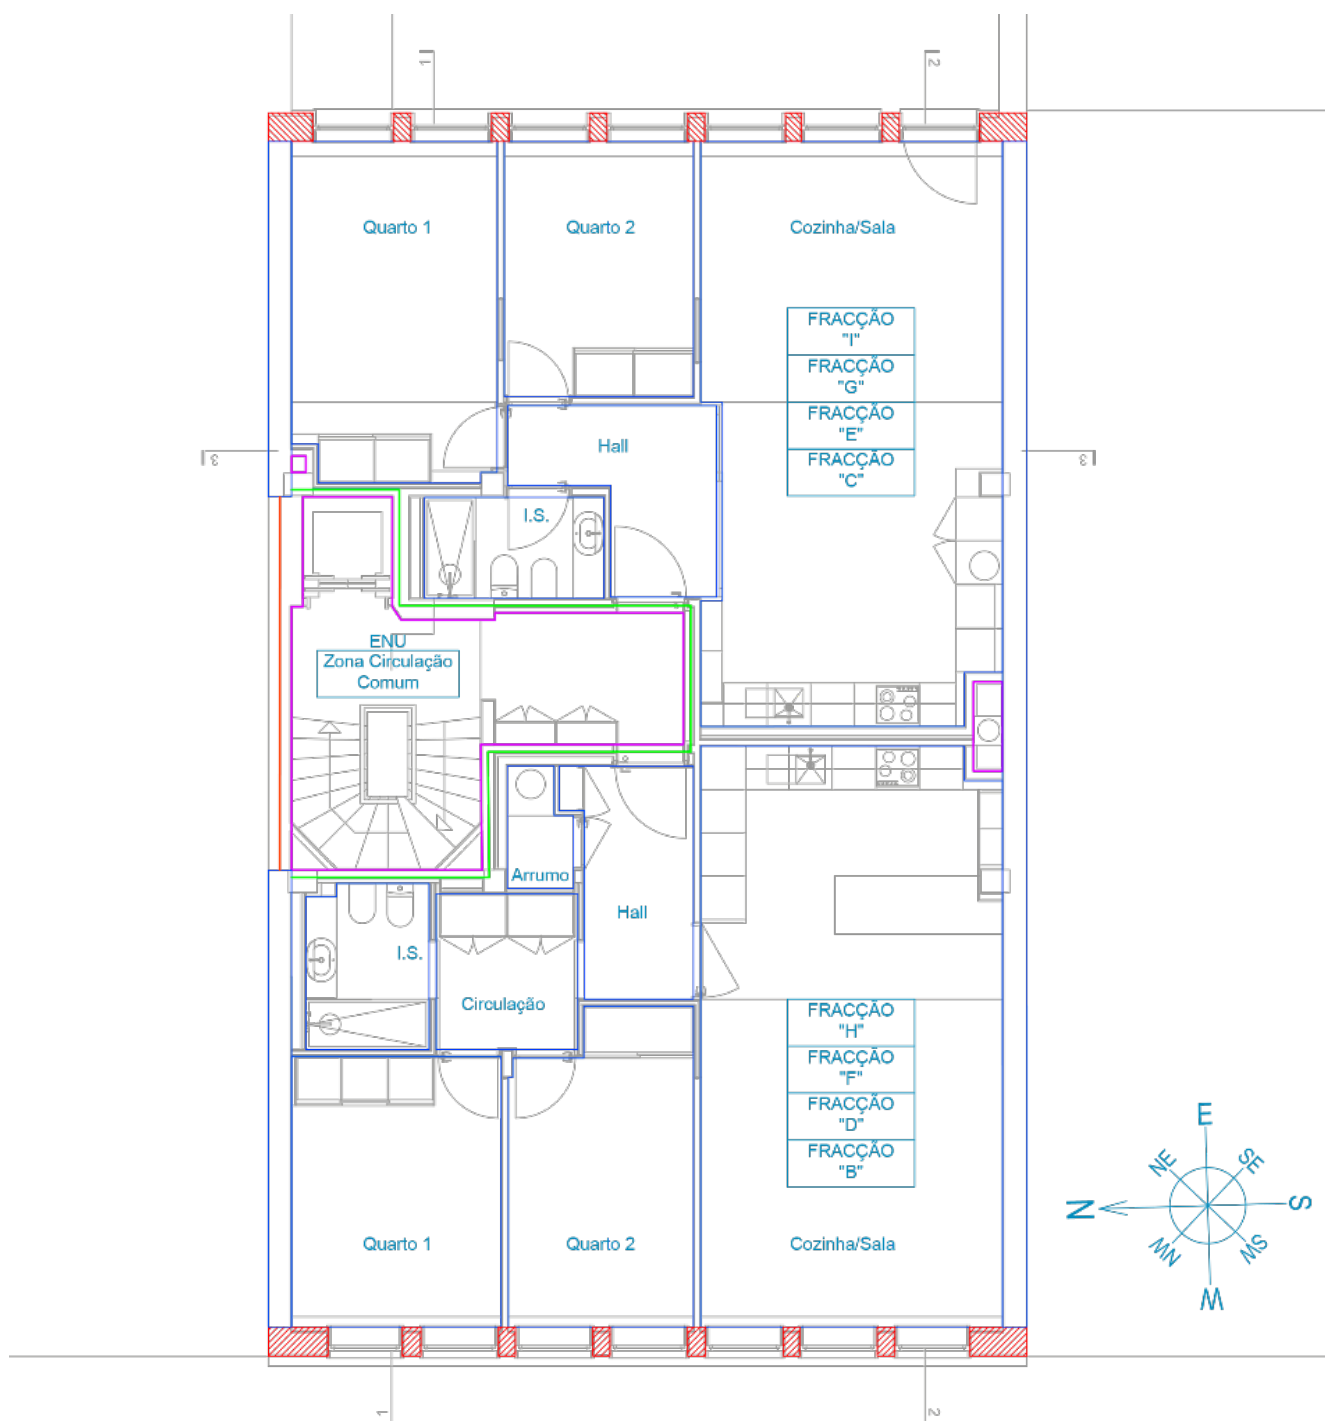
Planta do piso tipo (1.º, 2.º, 3.º e 4.º andar)
